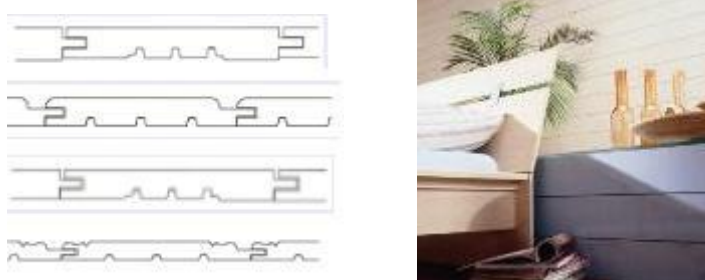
Secção transversal de modelos de lambris e exemplo de aplicação [23]
